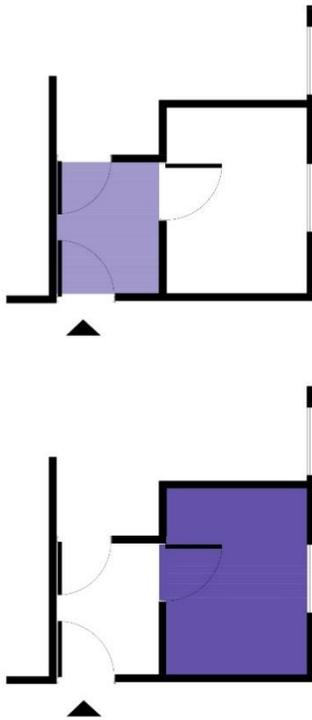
Ámbito de visitas y de trabajo. Fuente: Elaboración propia.
